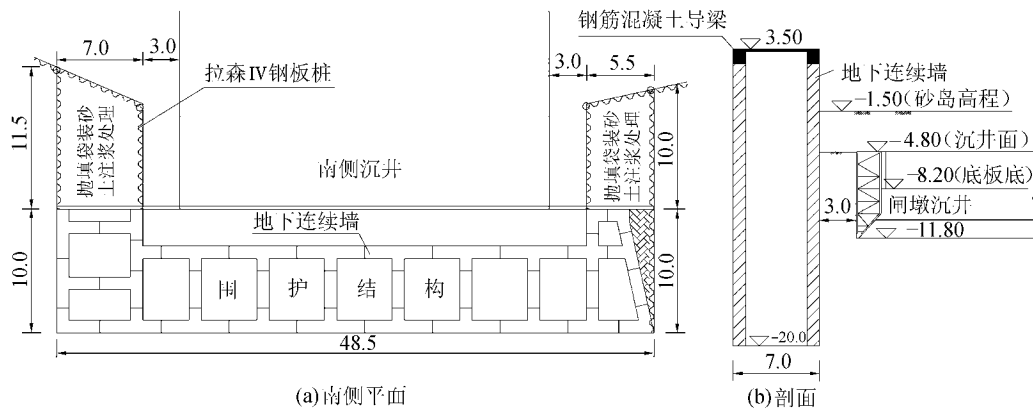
基坑围护结构平面布置及剖面示意图(单位:m)
